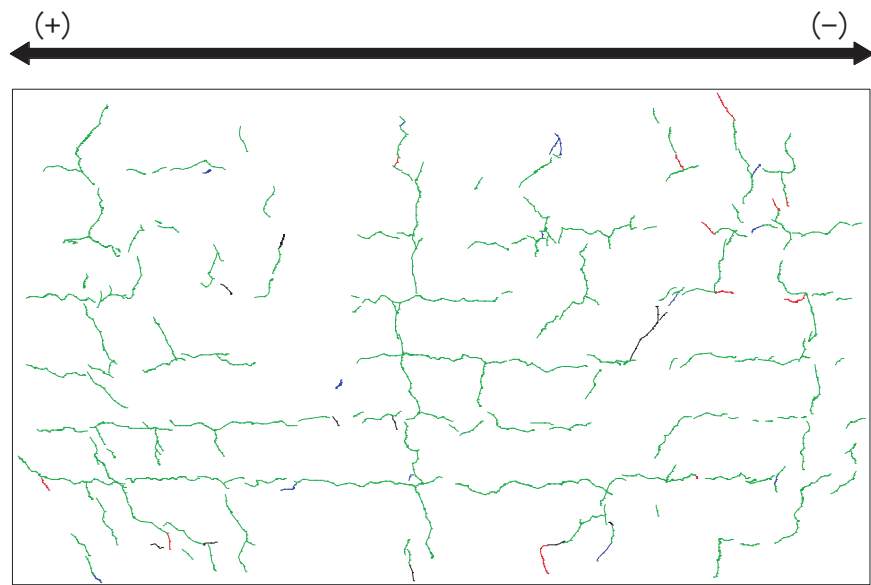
(3) 乾燥試験体 [2] 1/5000rad. におけるひび割れ図
